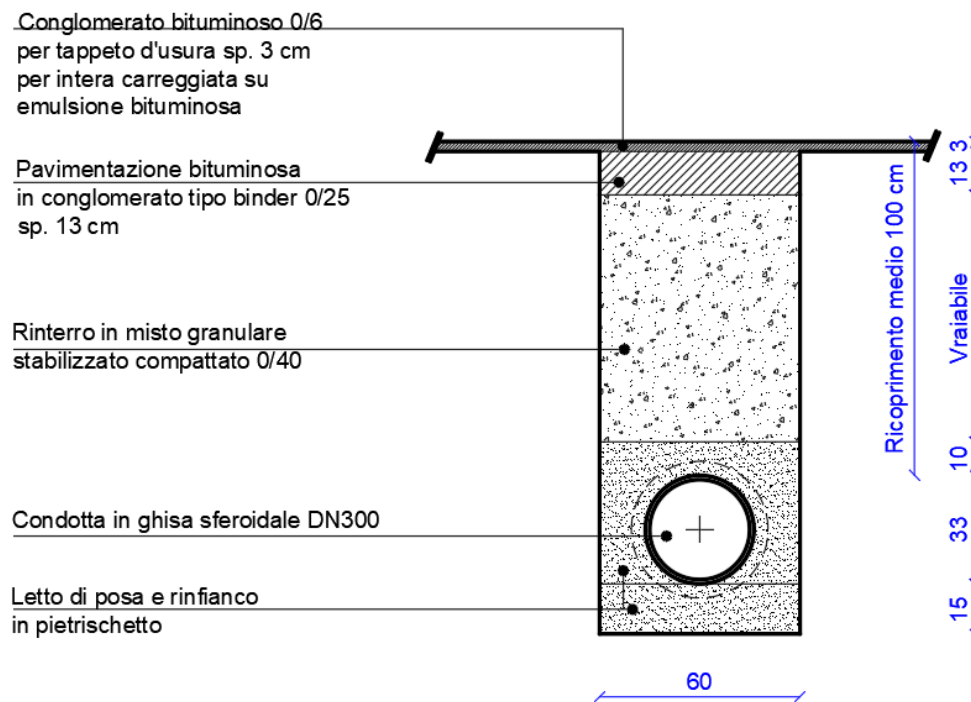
Sezione tipo di scavo e rinterro su strada comunale
